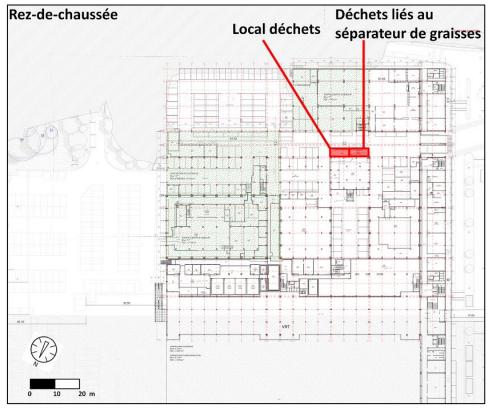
Localisation des zones de stockage des déchets au rez-de-chaussée (Fond de plan : MDW – V+, Annotations : AGORA)
